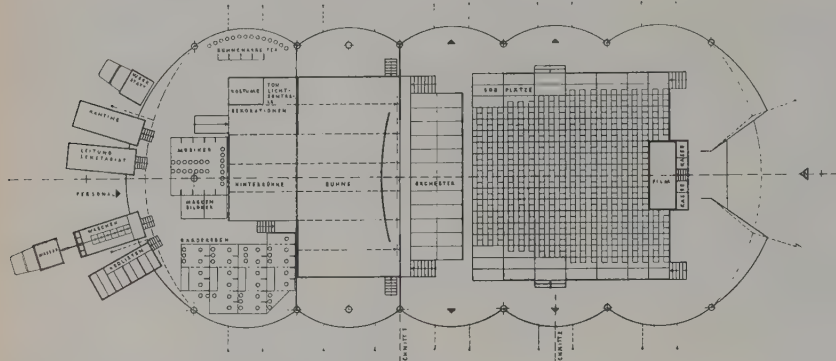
Grundriß des fertig aufgebauten Theaters 1:600
